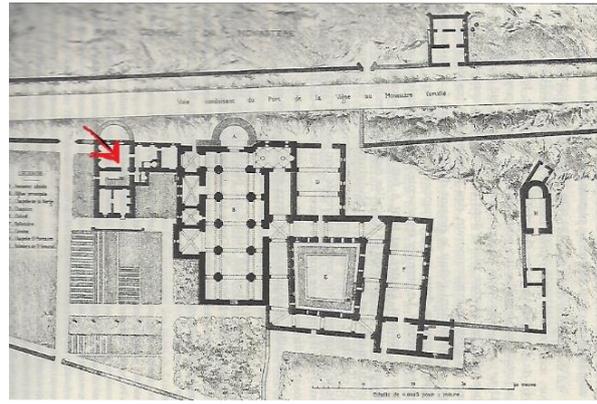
Grundriss mit ehemaliger Marienkirche nach Rekonstruktionen des XIX Jhts (H.Revoil)
